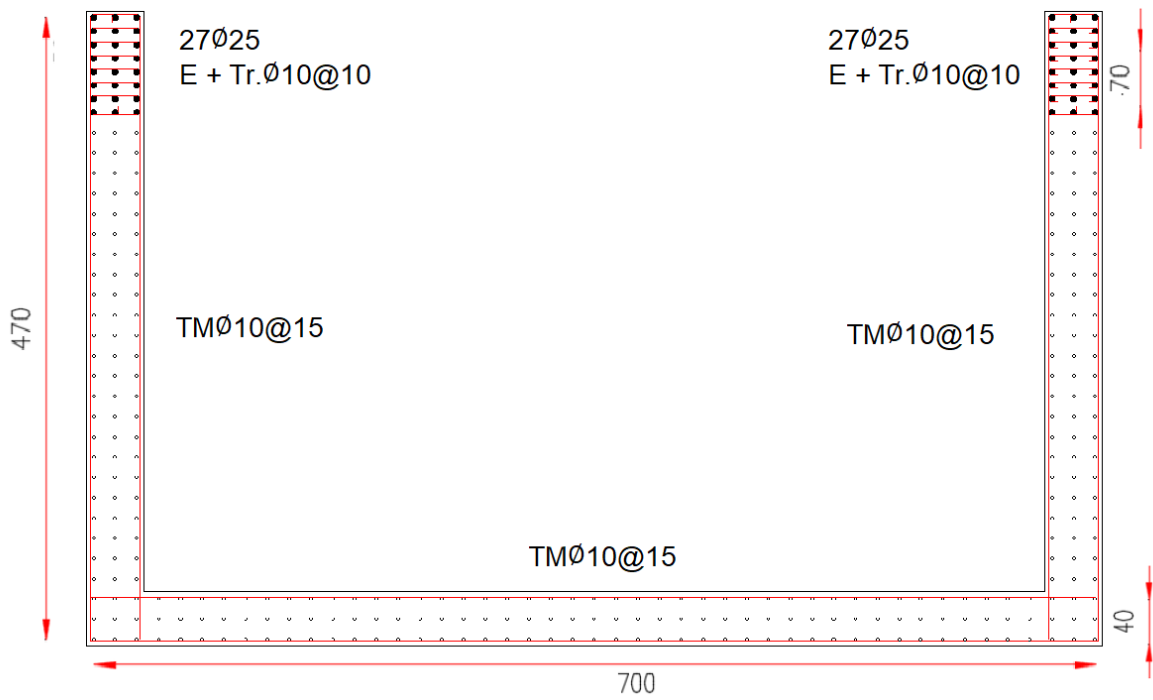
Disposición de armadura muro C modelo de 15 pisos.
